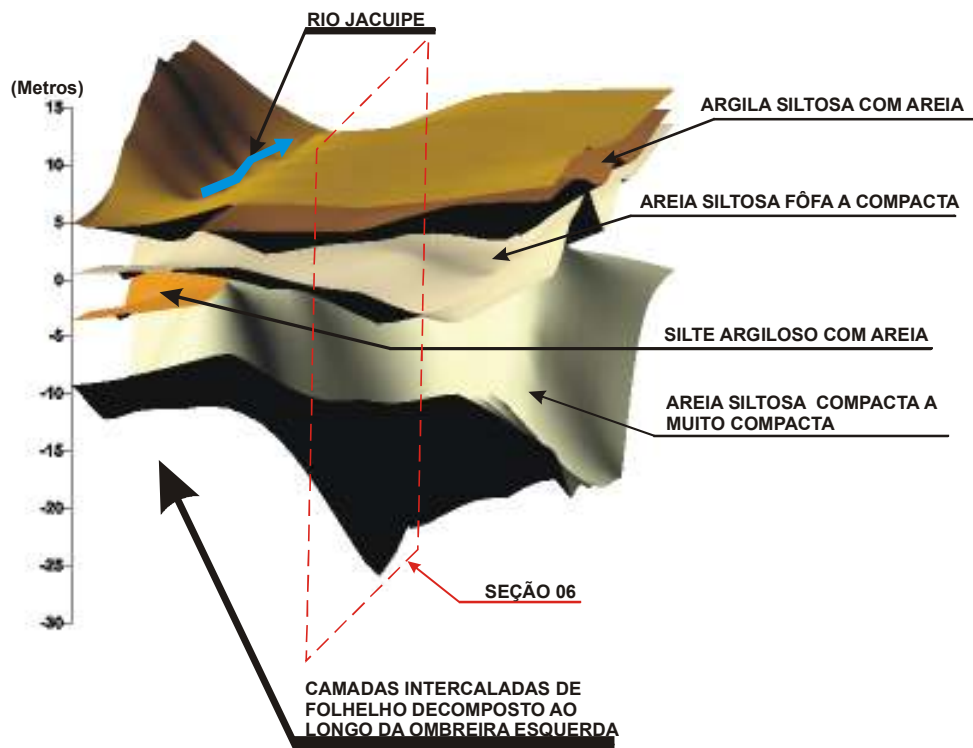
Perfil 3D do sítio da Barragem de Santa Helena
